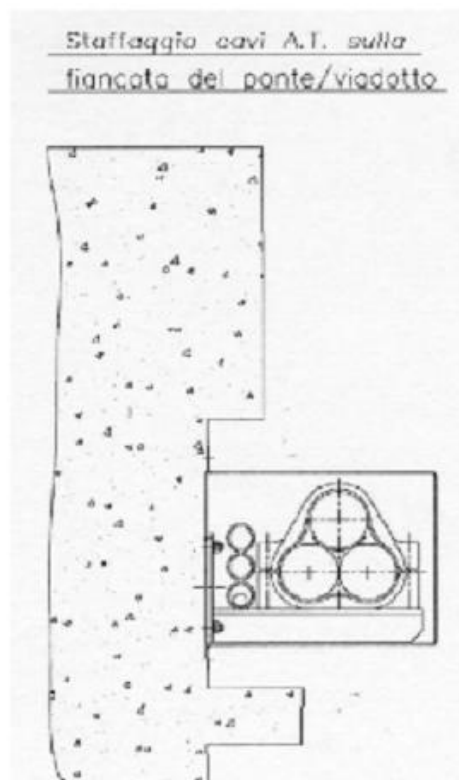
Sezione tipica di posa di una terna di cavi a 220kV con ancoraggio a viadotto
